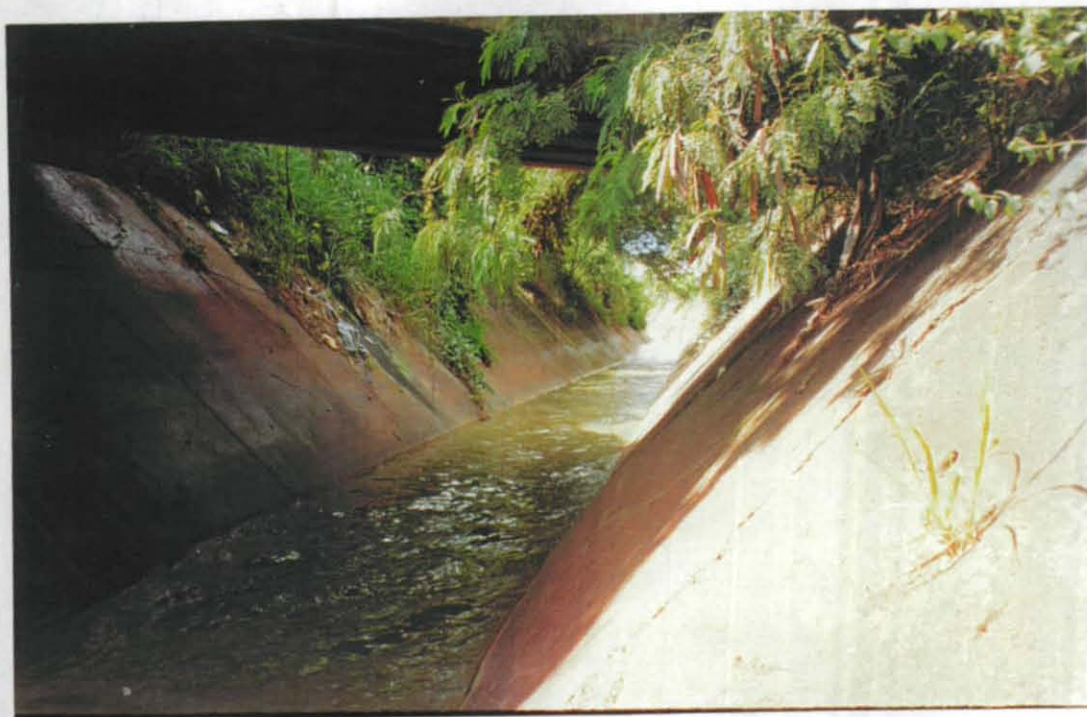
INS P - F8 VISTA LATERAL PUENTE DEL FERROCARRIL DESEMBOCADURA CANAL CVC SUR
